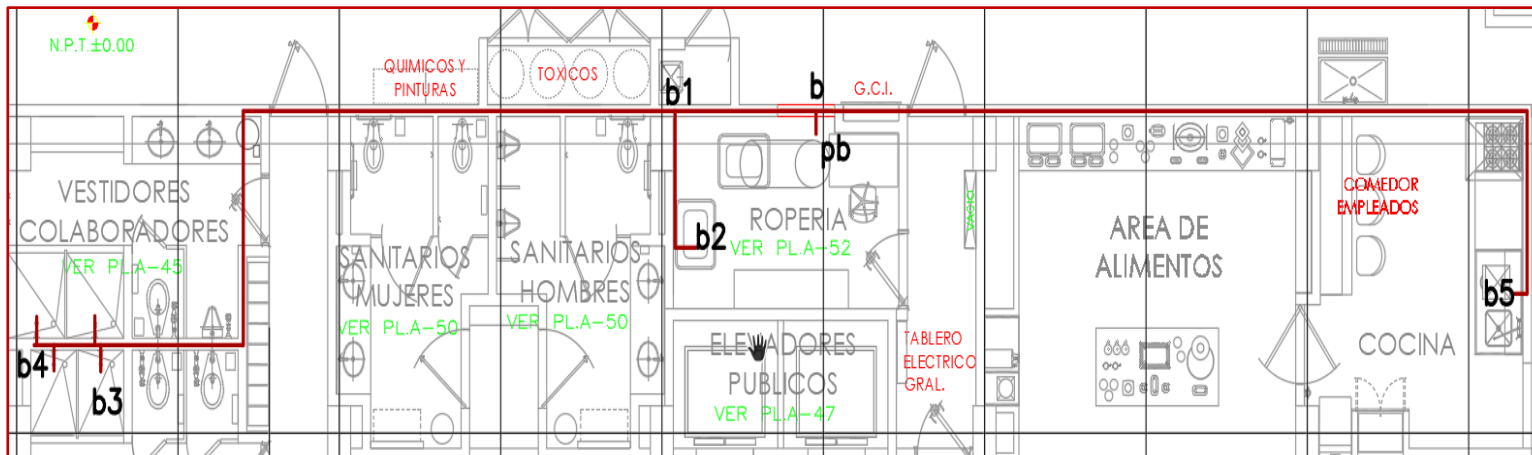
Trayectoria propuesta, red de agua caliente, Nivel Planta baja.
